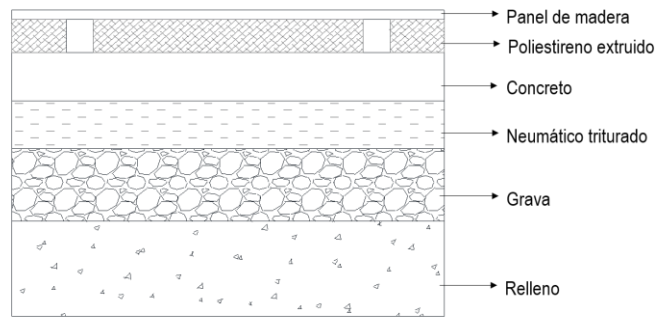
Detalle en 2D de placa de hormigón con aislamiento en poliestireno extruido
